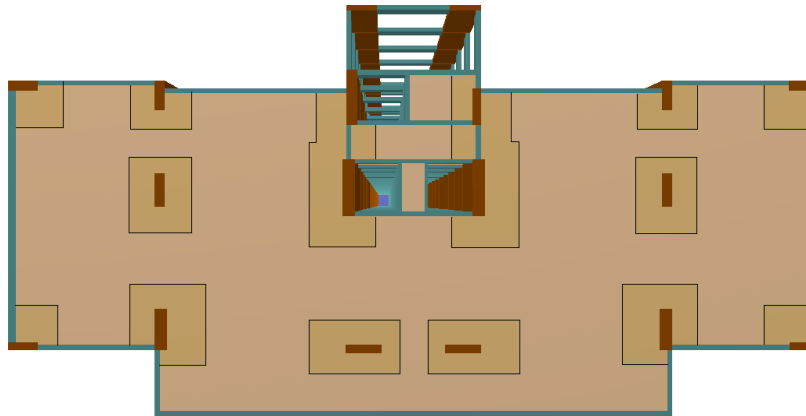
Pavimento tipo de laje lisa com vigas de borda (AUTORES (2020))
